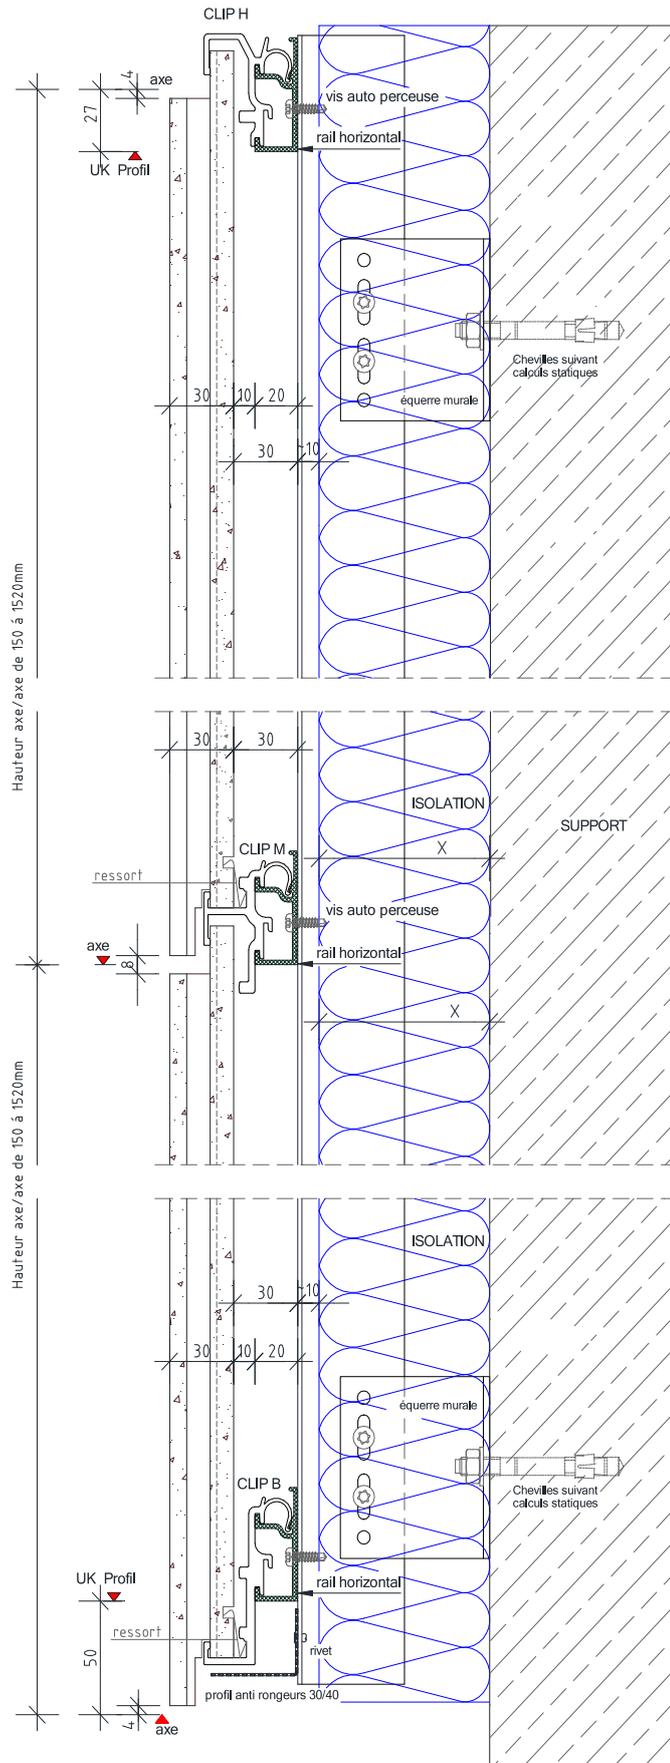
Coupe verticale avec rail Gén 06'75 ouvert
